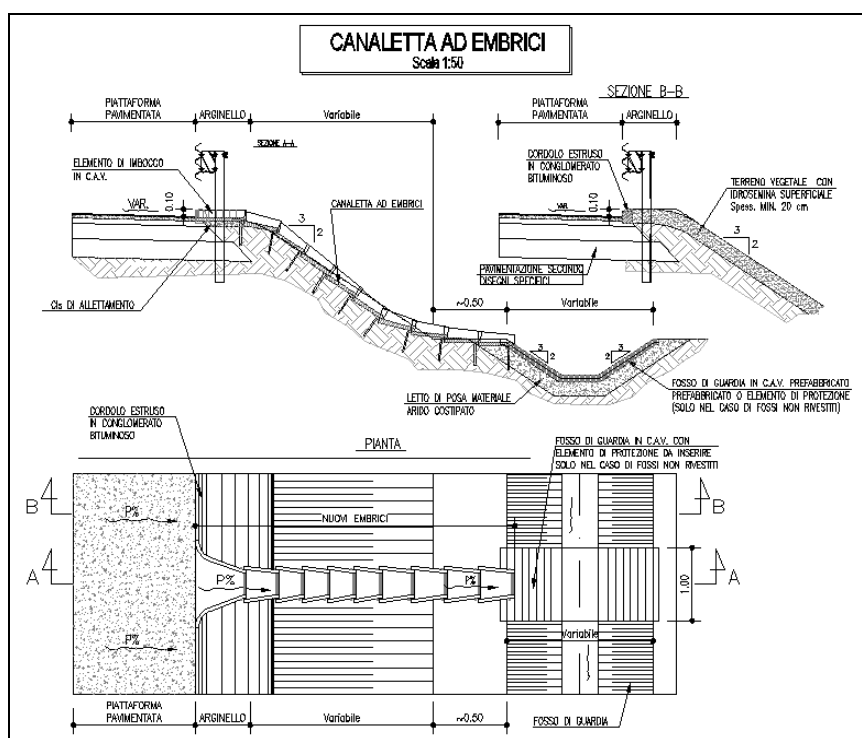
Pianta vista e sezionbne tipologia scarico con embrici
